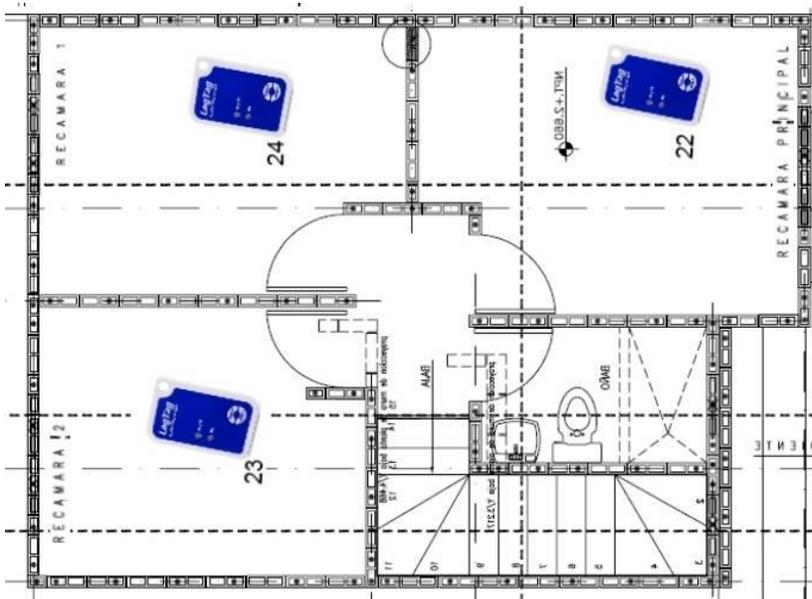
Planta arquitectónica de la vivienda cuatro, primer nivel. Orientada al Norte
